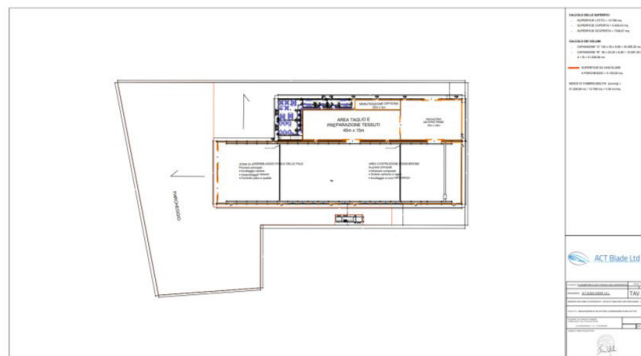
Planimetria (cfr TAV. A2 - PLANIMETRIA E DATI TECNICI DELL'INTERVENTO - 19/04/2023)
